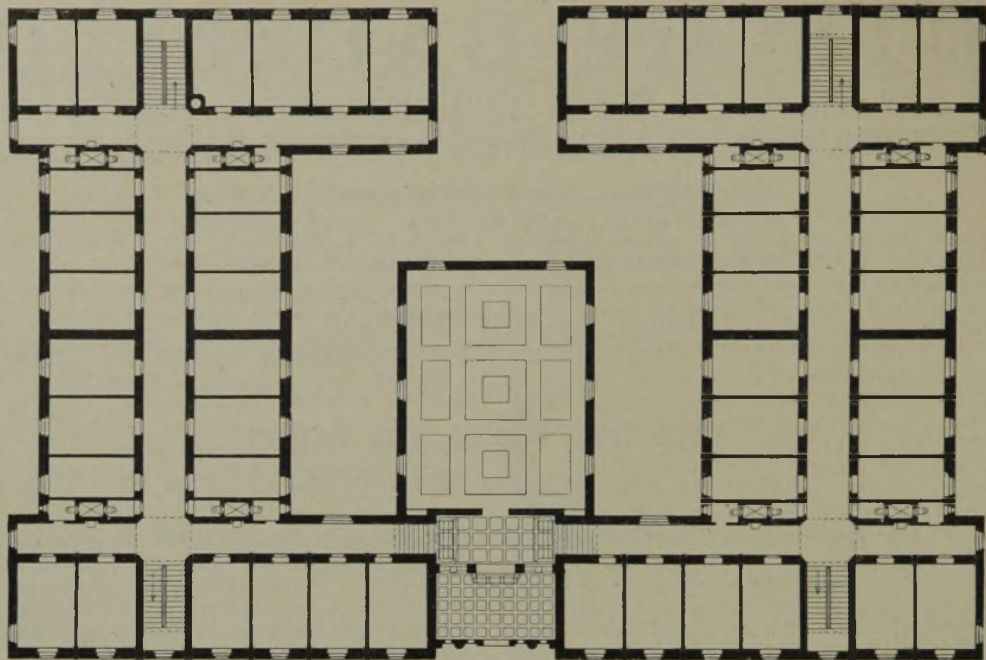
(oben). Grundriß des Obergeschosses. (1 : 500.)
